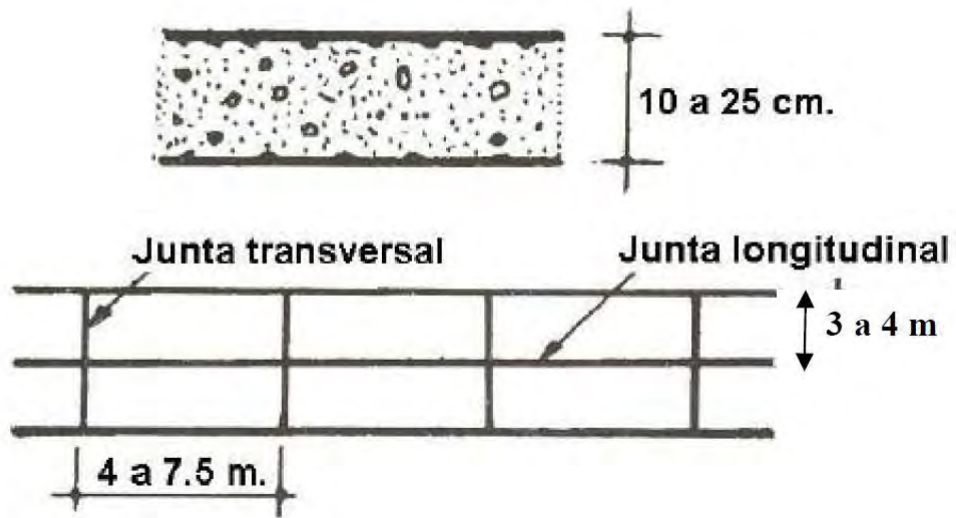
Pavimento de concreto simple sin pasadores. Fuente ASOCCEM (2016)
